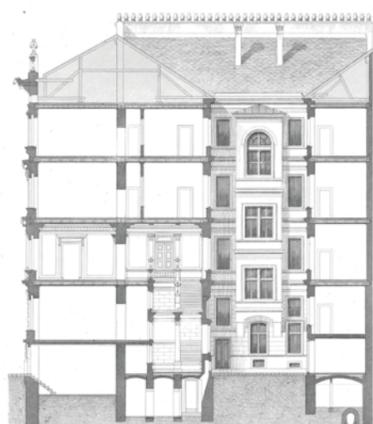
Schwindgasse 2 – publizierte Pläne 1879, Einreichplan 1875 (Lageplan)
